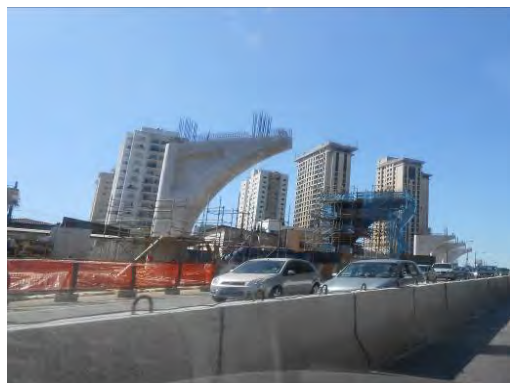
Vista geral da obra do Monotrilho.
